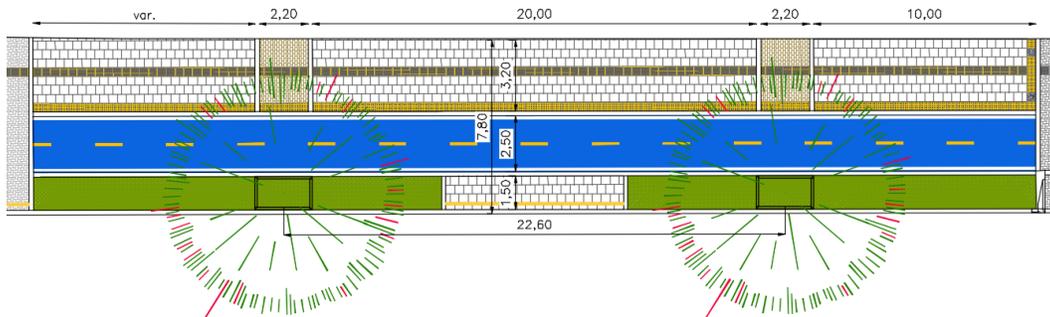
Propuesta de Franja de circulación peatonal - Planta
